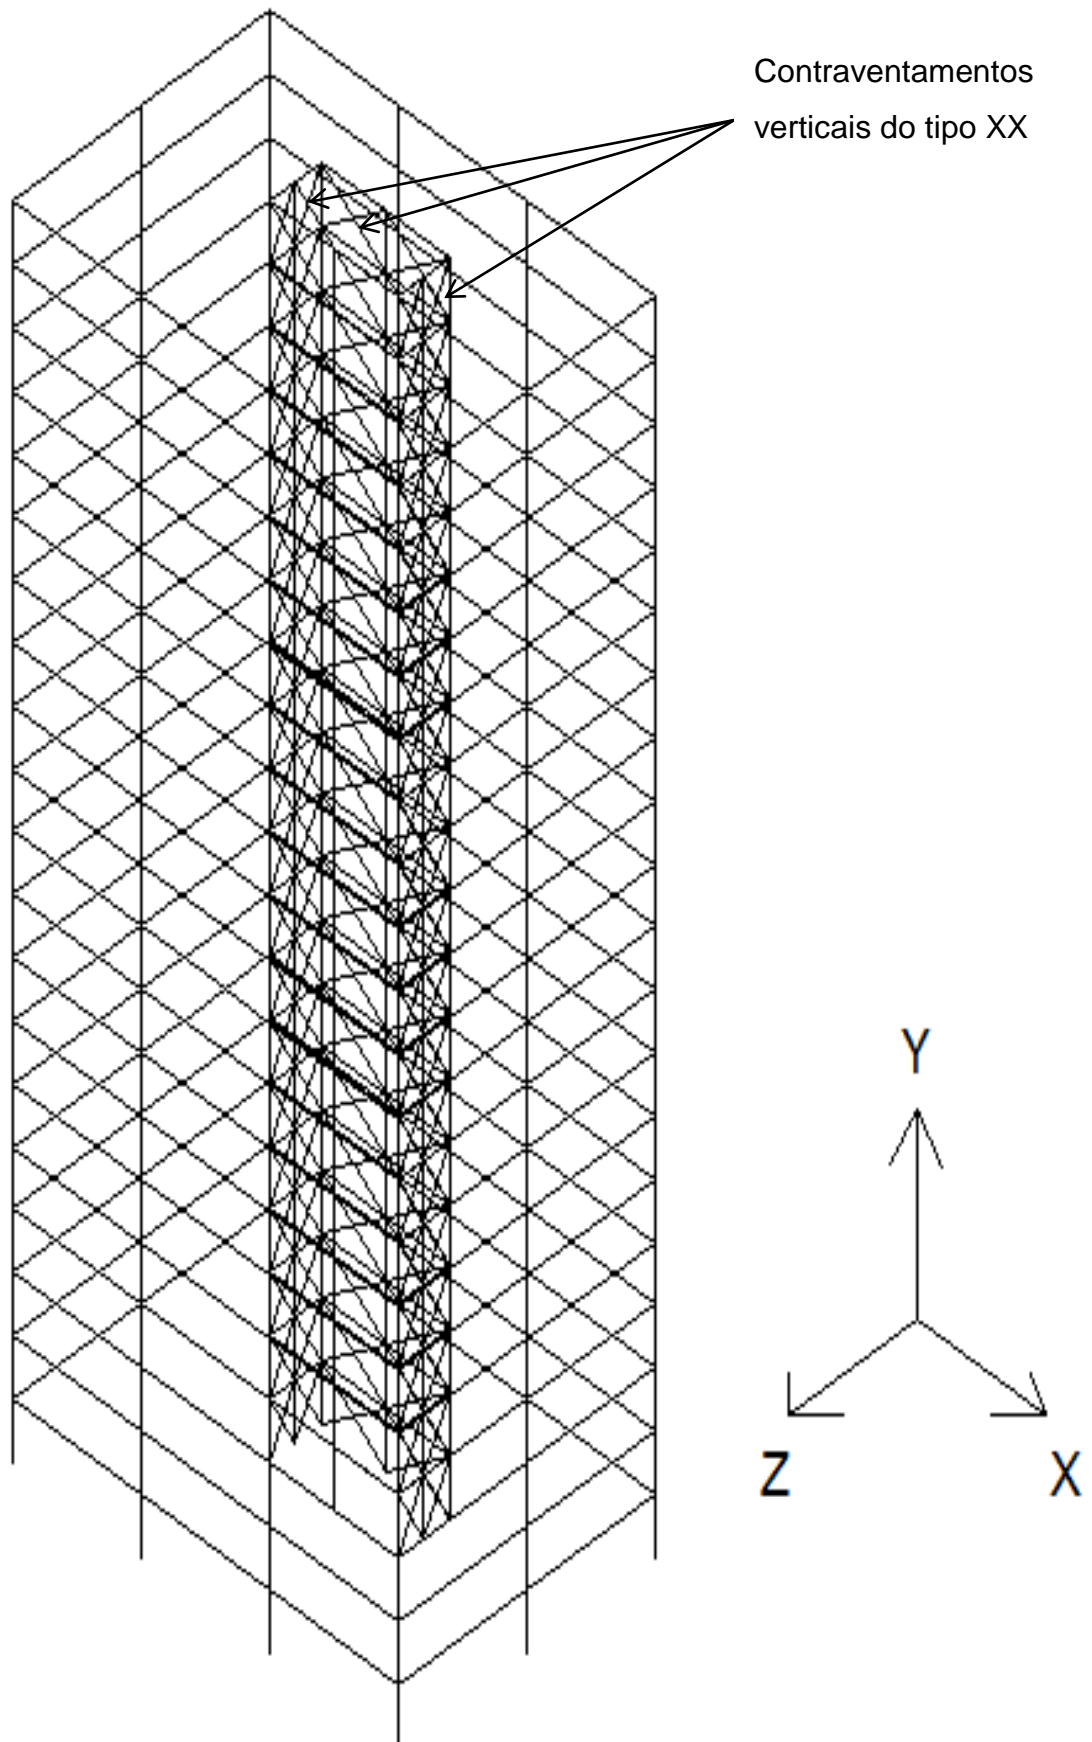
Modelo tridimensional do edifício com núcleo contraventado em XX.
